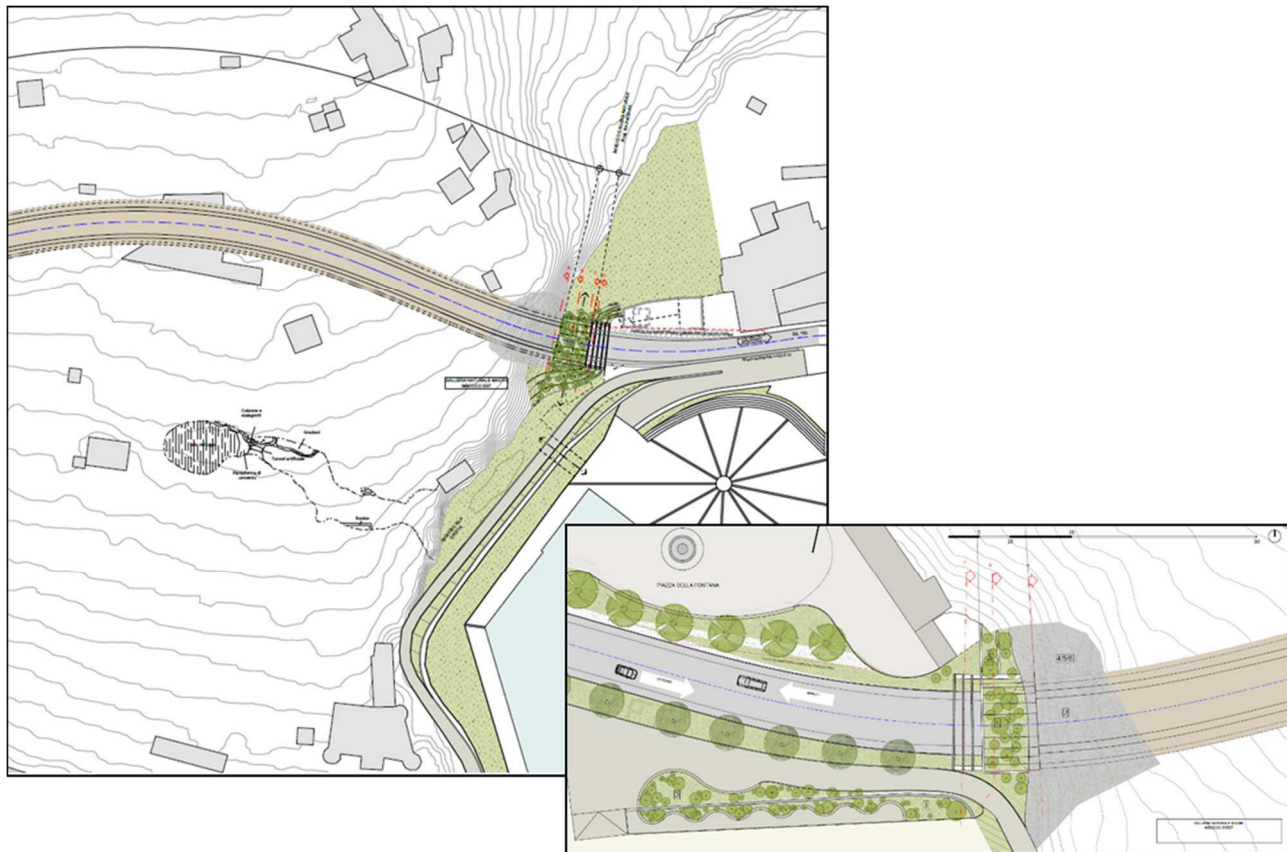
Sistemazione lato Maiori (sx) e particolare imbocco (dx)
